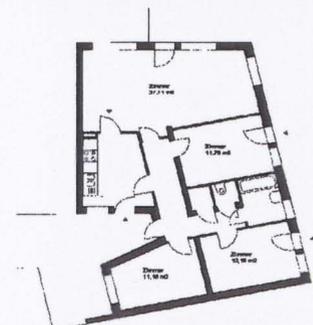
Wienerberger 2. BA, Grundriss
